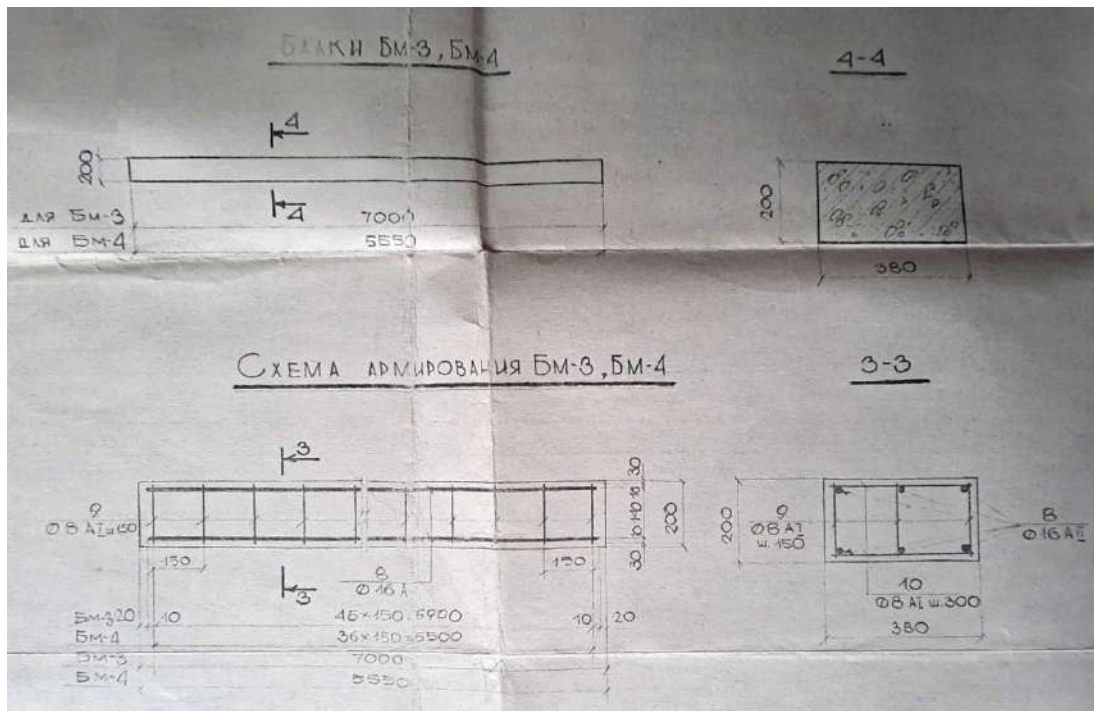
Опалубочне креслення та схема армування балки монолітної залізобетонної БМ-4 згідно з проектною документацією
